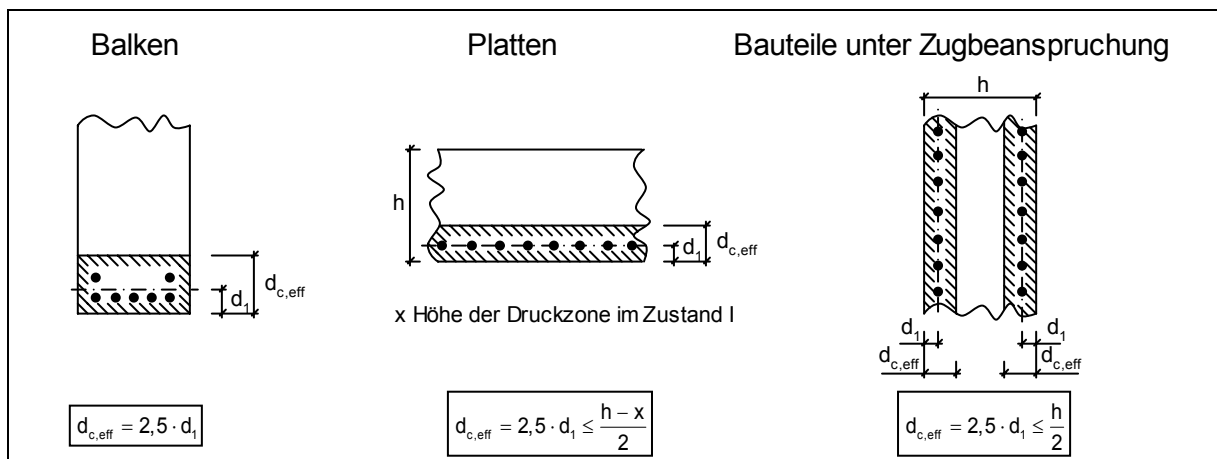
Effektive Betonzugfläche im Wirkungsbereich der Bewehrung nach DIN 1045-1
